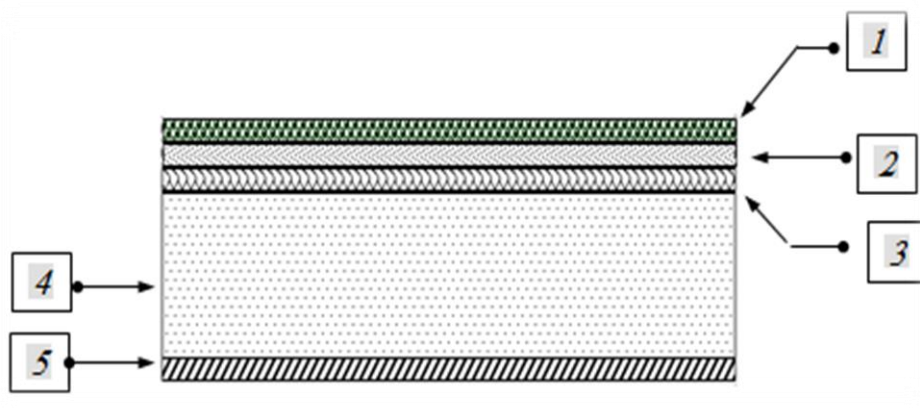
Coupe verticale du plancher courant à dalle pleine.
